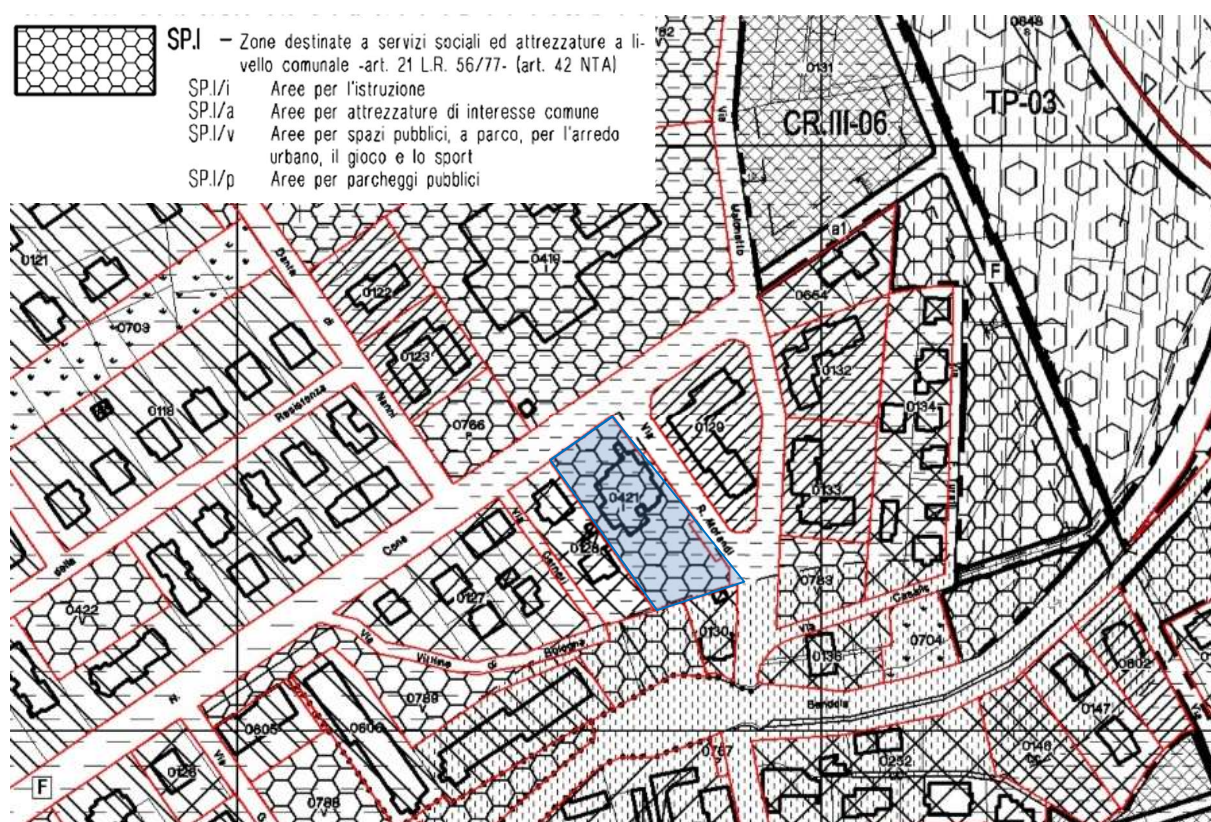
Estratto Tav. P.2.5 v-3 – Planimetrie di progetto: territorio con individuazione area oggetto di intervento – Fuori scala.
